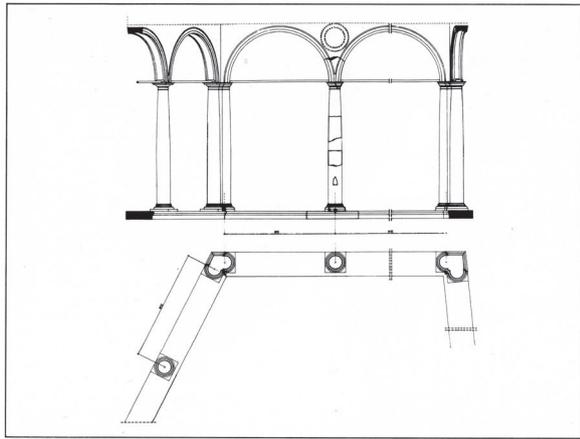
Rekonstruktionszeichnung der Renaissance-Loggia. Ansicht und Grundriss. – Maßstab 1 : 50.
